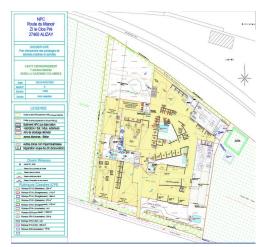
Plan du site (source: A0 Plan d'ensemble)
